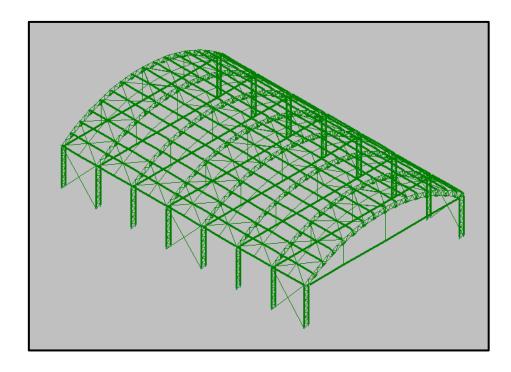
Estrutura com contraventamos horizontais , verticais e tirates entre pilares.
